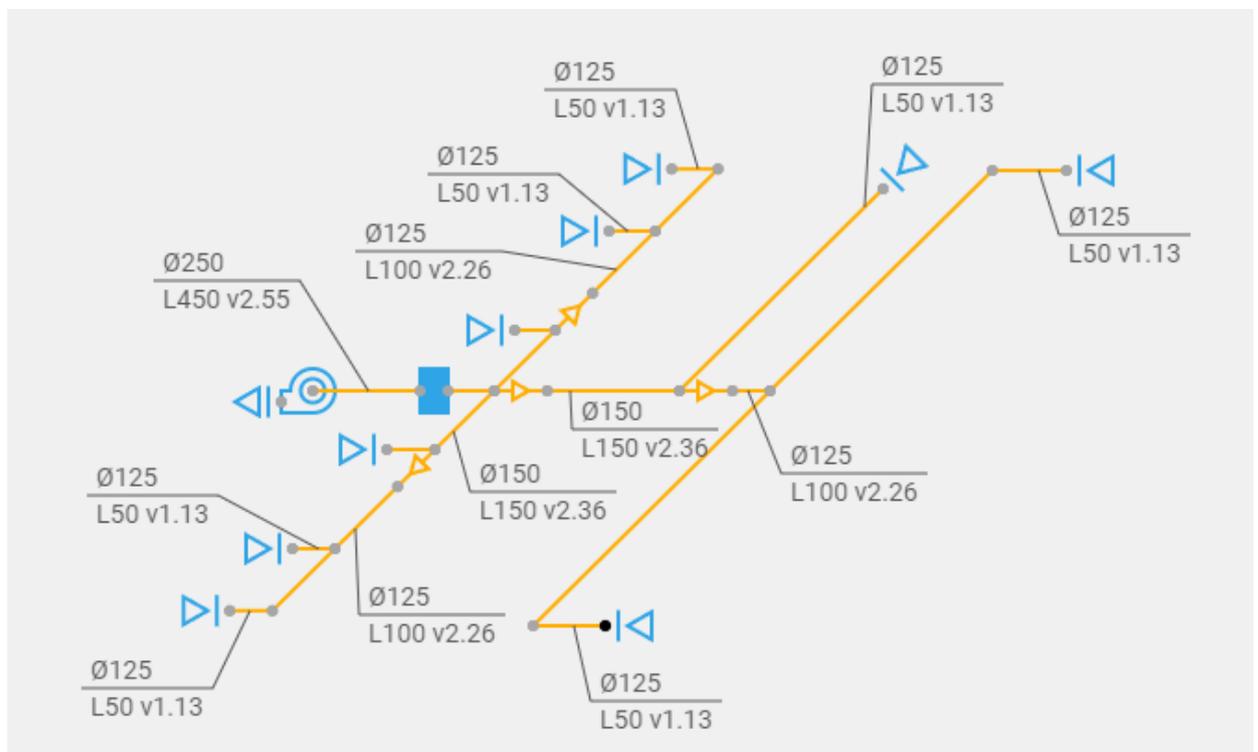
Фрагмент схеми вентиляції ПВ-14(витяжка).
